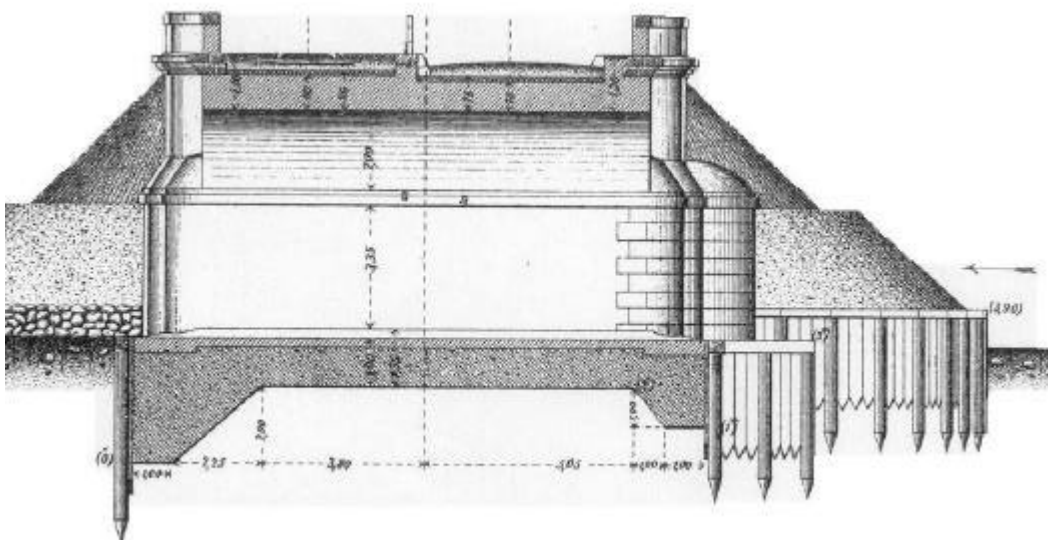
Sezione trasversale di fondazione a platea (Curioni, 1871).
